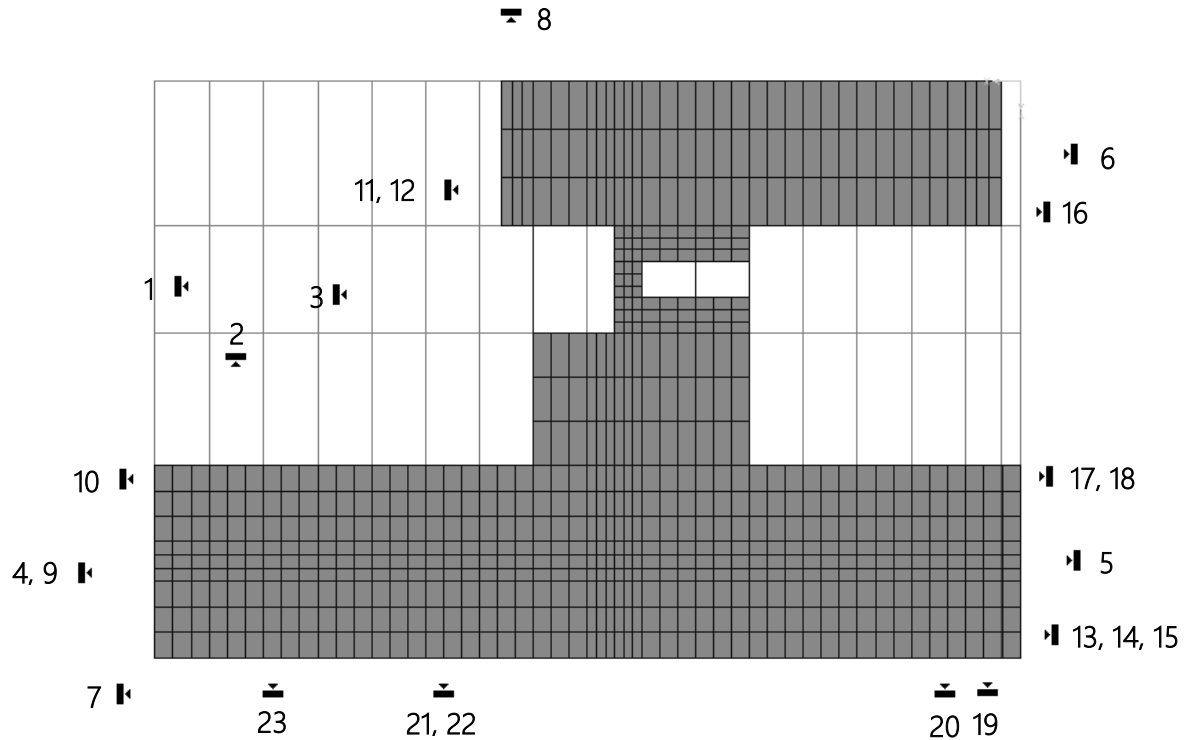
Ubicación en planta de las fotografías tomadas en el exterior del edificio.
